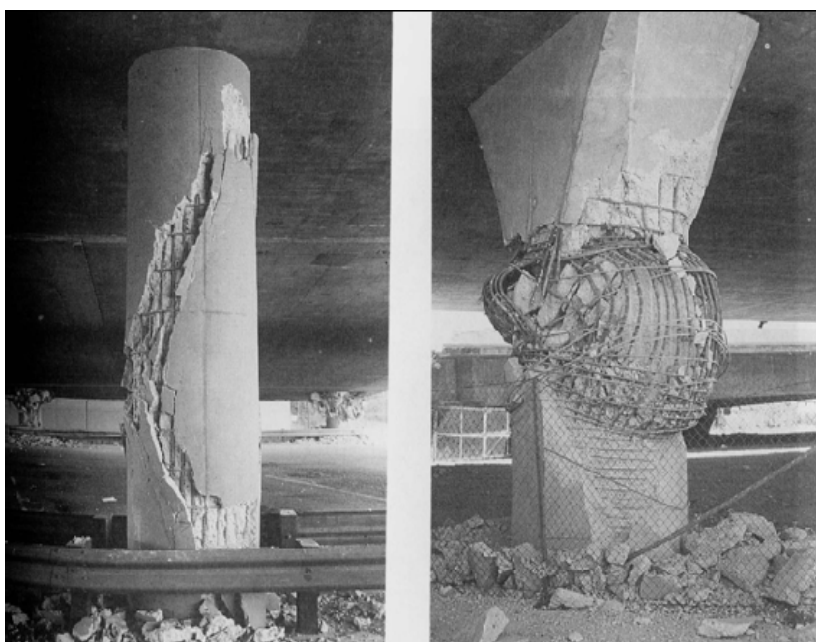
Ejemplos de fallas por cortante en el terremoto de Northridge. (a) Columna I-10 de la Autopista en Fairfax/Washington; (b) I-118 Mission/Gothic. (Tomada de Priestley, Seible y Calvi, 1996)
